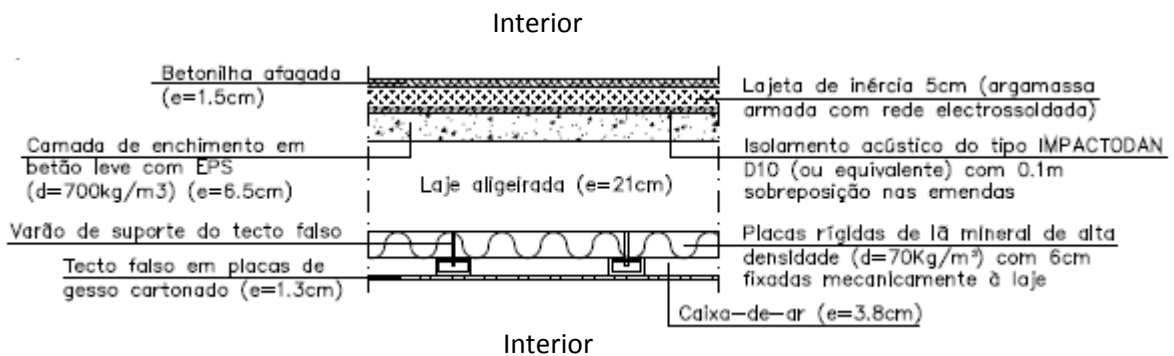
Pormenor construtivo do pavimento 2 [17]
